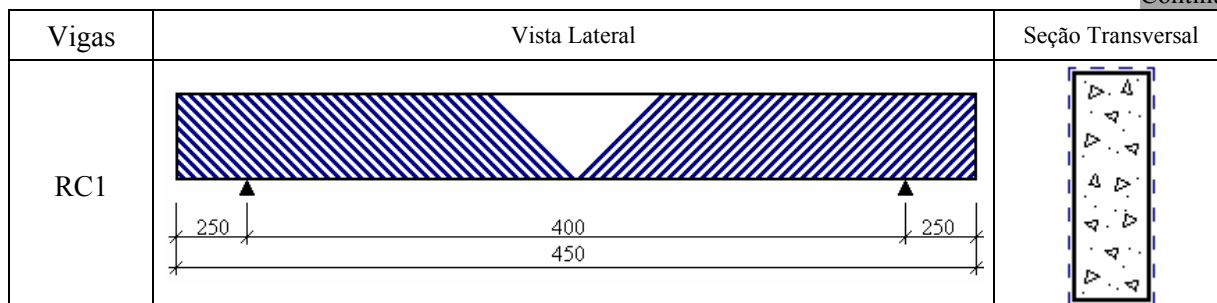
Armadura das vigas do experimento de TALJSTEN & TEKNIK (2001)
